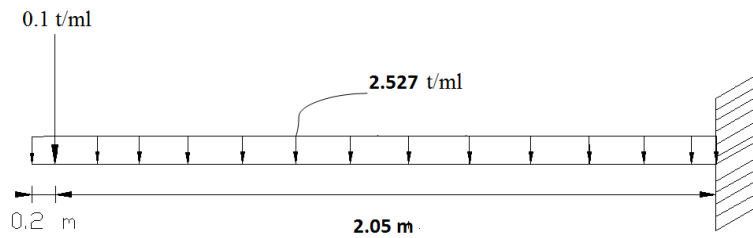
Poids propre sur la dalle d'encorbellement
